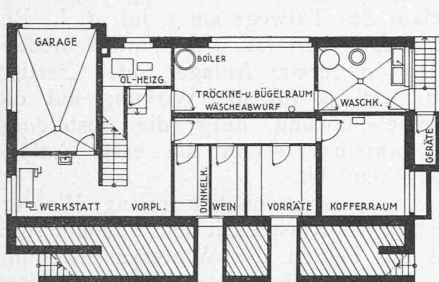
bis 7. Grundrisse vom Unter-, Erd- und Obergeschoss. — Masstab 1 : 300.
